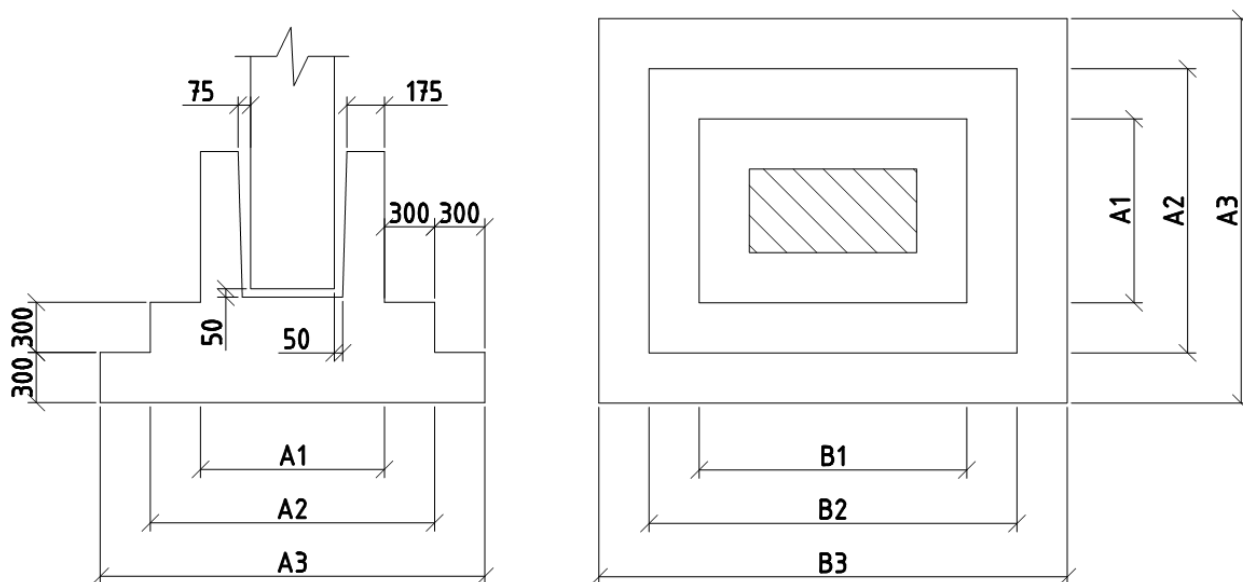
Фундамент стаканного типа для колонн одноэтажных промышленных зданий
